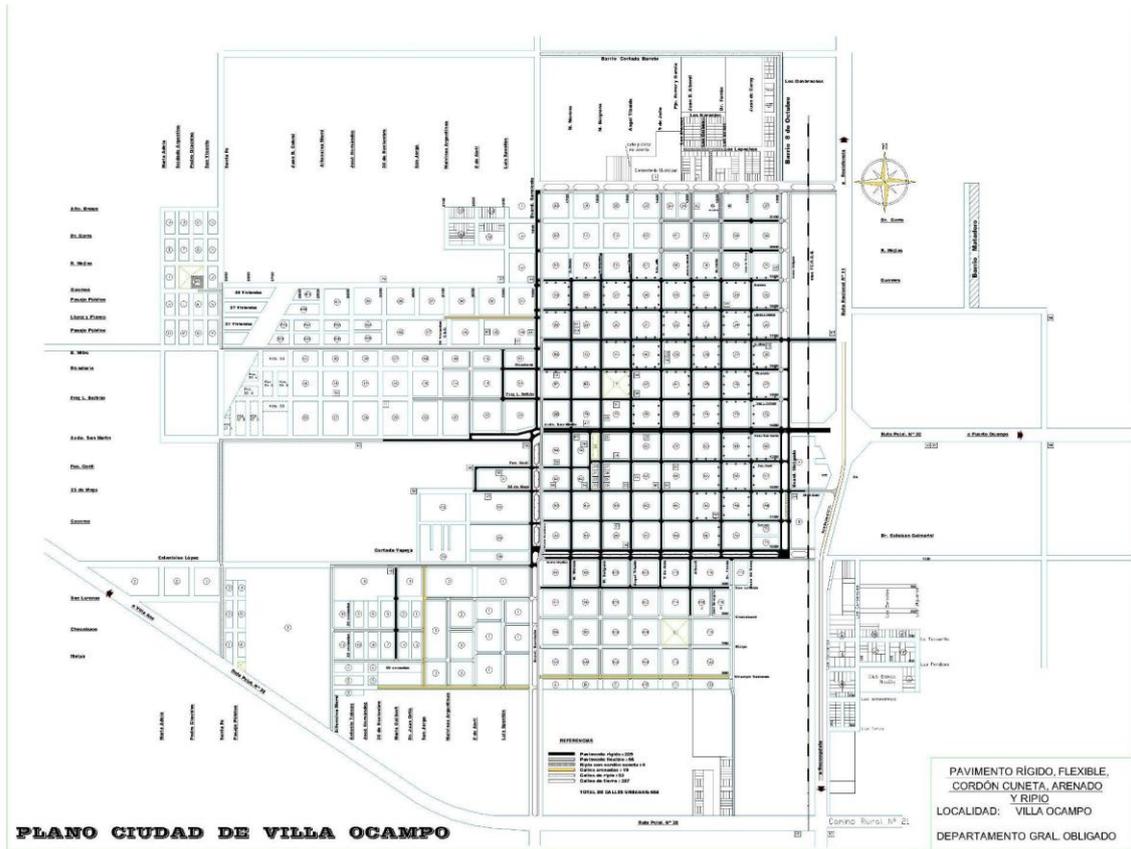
Planta urbana de infraestructura vial (pavimento rígido, flexible, cordón cuneta, arenado y rípiado)
